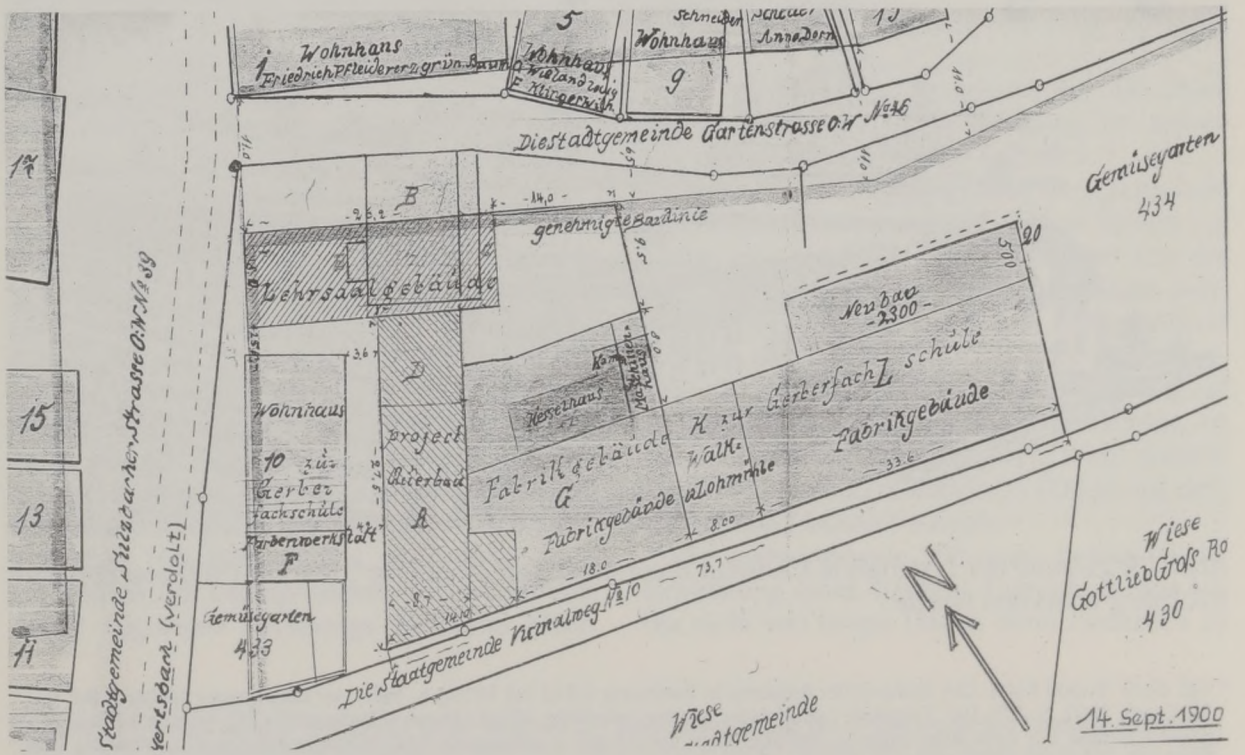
Geplante bauliche Veränderungen zur Einrichtung einer Gerberei-Fachschule (Lageplan von 1900).
